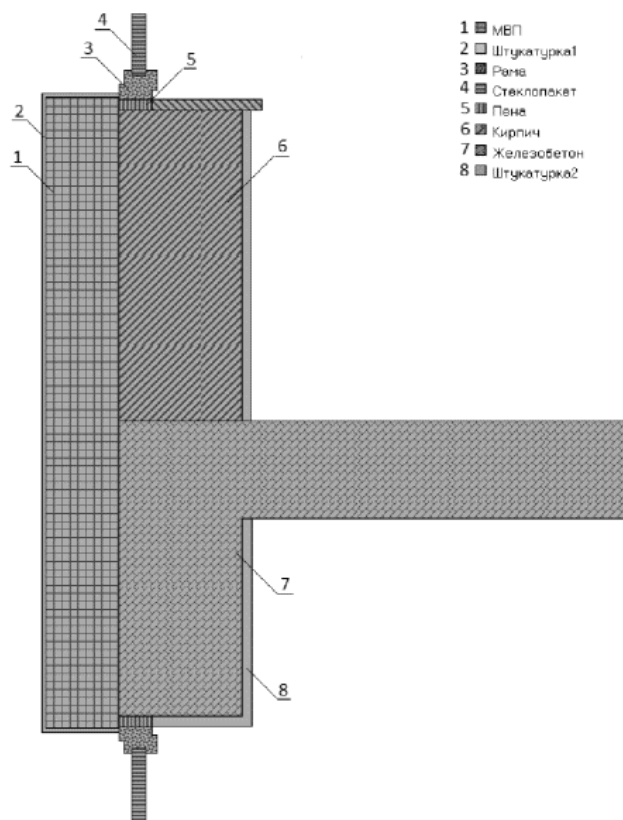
Схематическое изображение вертикального разреза стены с теплоизоляционным фасадом в зоне расположения светопроемов с оконными блоками
